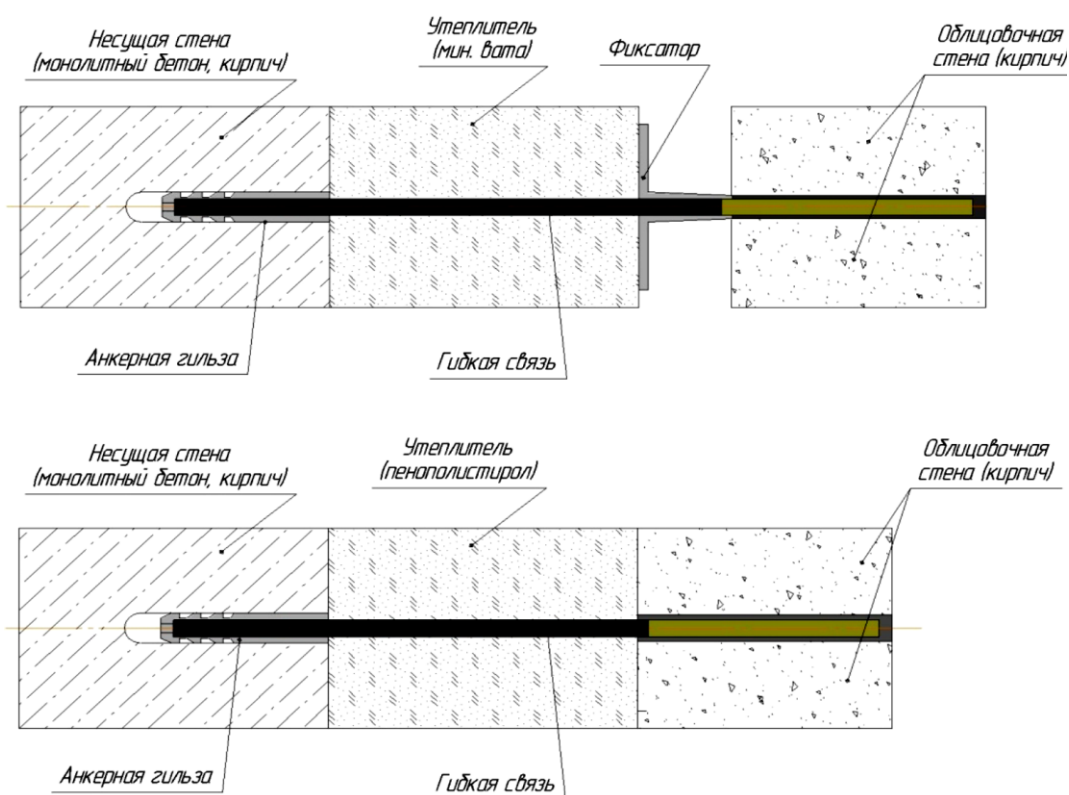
Конструкция трехслойных стен с несущим внутренним слоем из кирпича или керамзитобетонных блоков, с наружным слоем из кирпича
